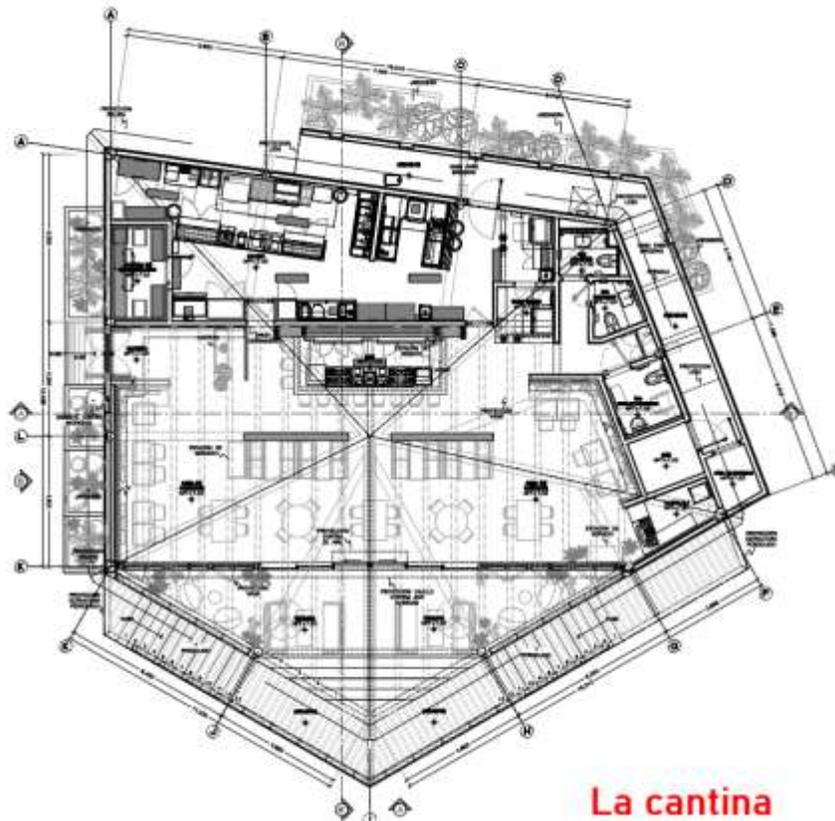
RESTAURANTE LA CANTINA.
